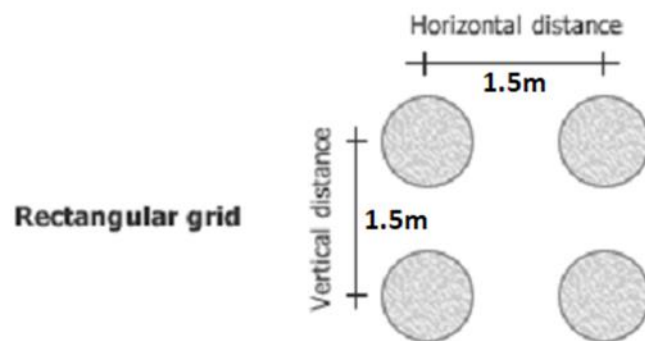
Maillage (Section 4 partie 1 crête).
